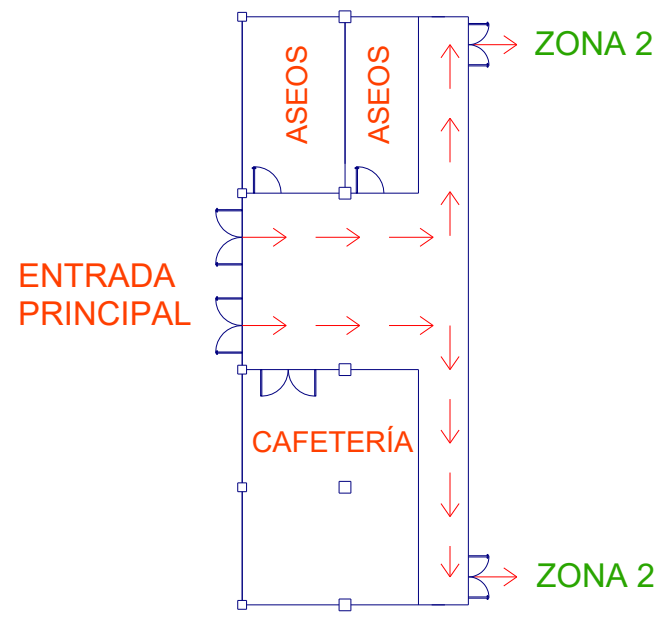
Distribución en planta de la Zona 1 del edificio.
